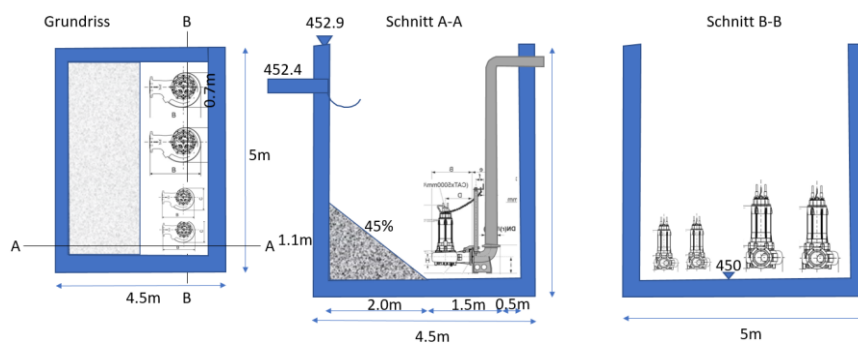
Grobskizze zur Dimensionierung des neuen Zwischenhebewerks
